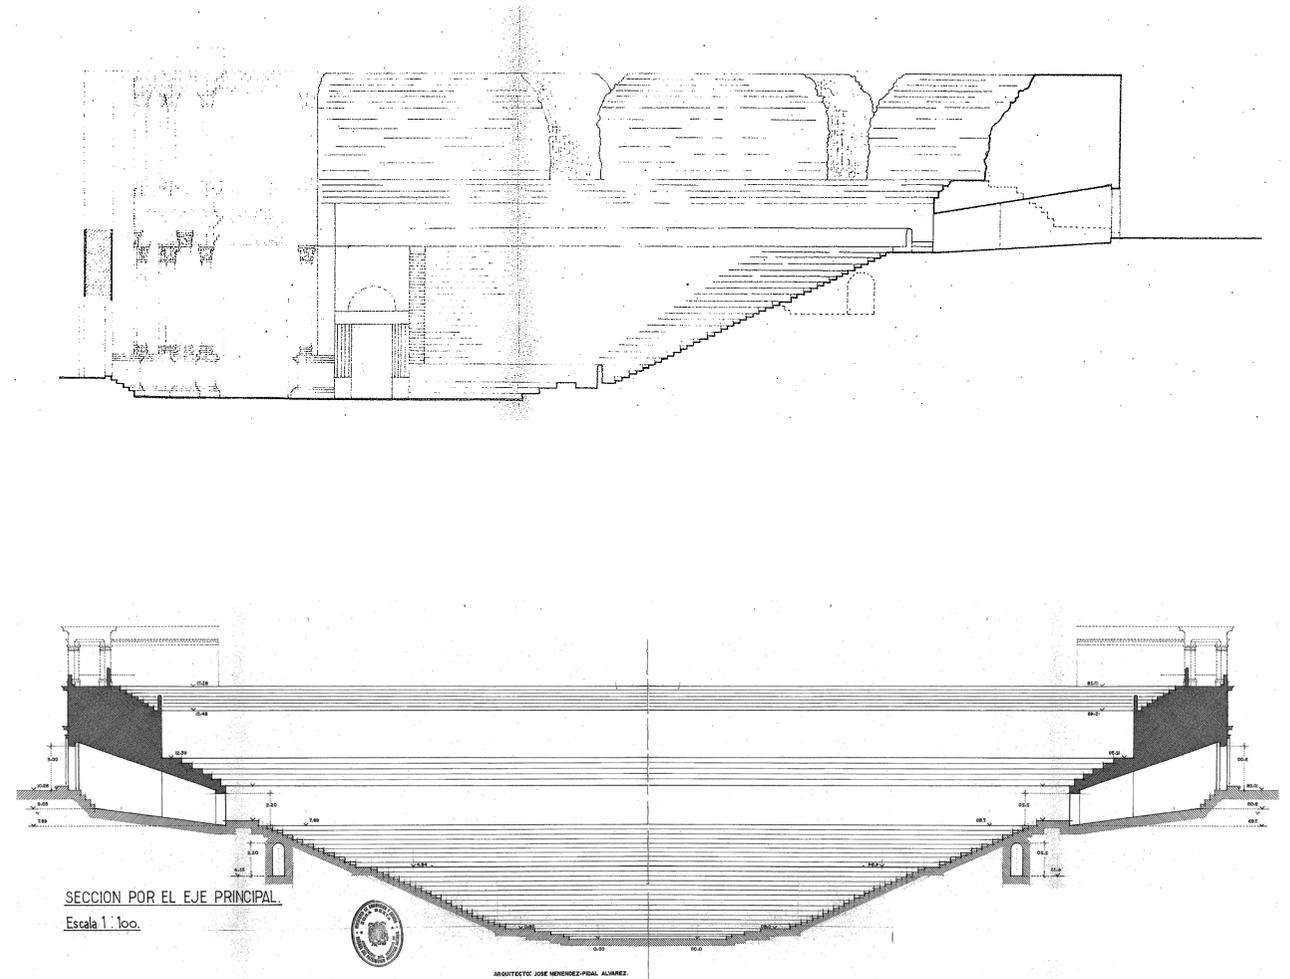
Sección transversal del conjunto. Sección alzado de la cavea. Por José Menéndez-Pidal .
